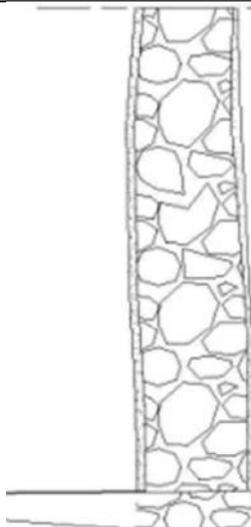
schémas de mur extérieur d'une maison traditionnelle à El-Ksar
